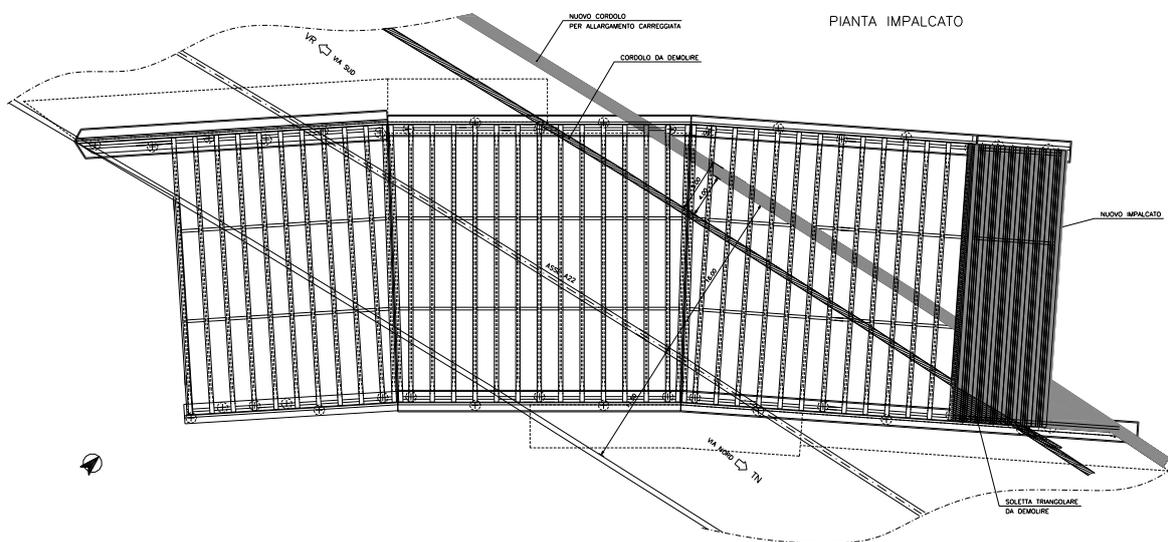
Pianta dell'impalcato del ponte sul canale S.I.M.A. nella configurazione di progetto
